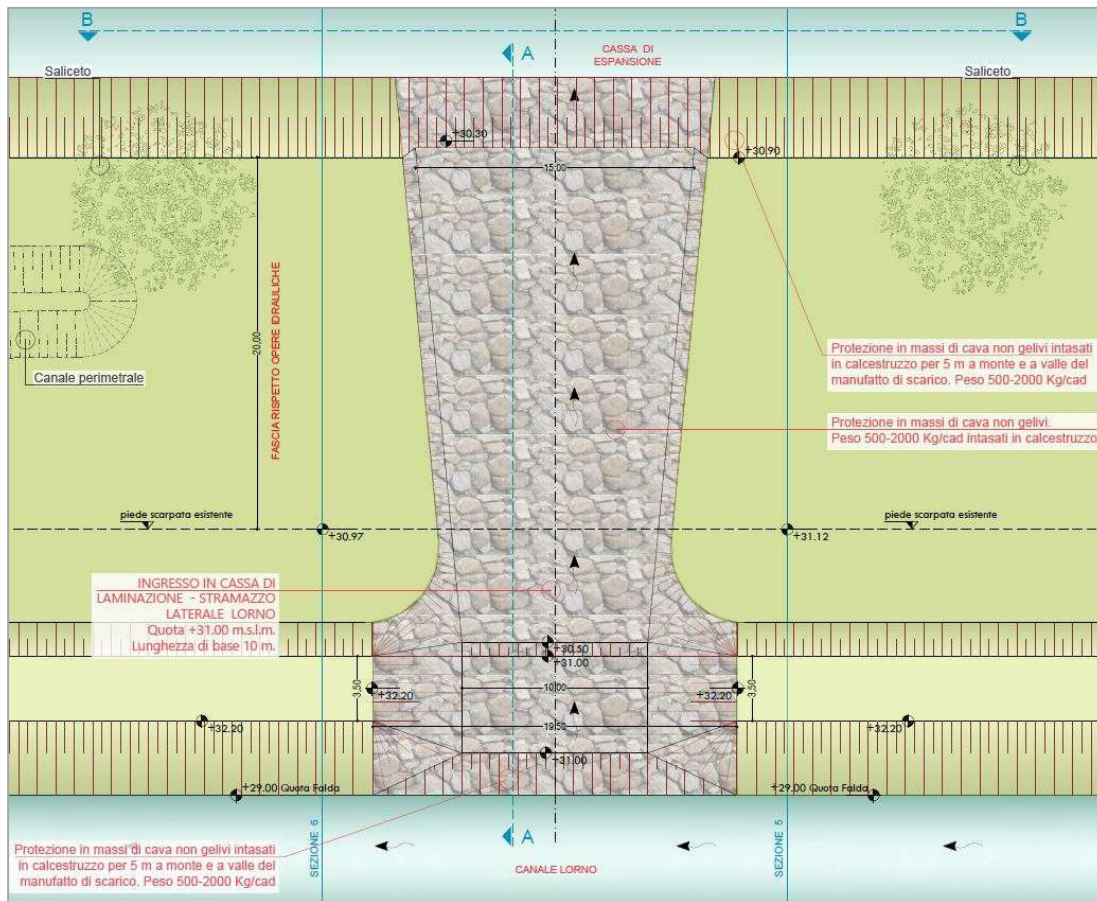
Manufatto di ingresso canale Lorno: planimetria.
